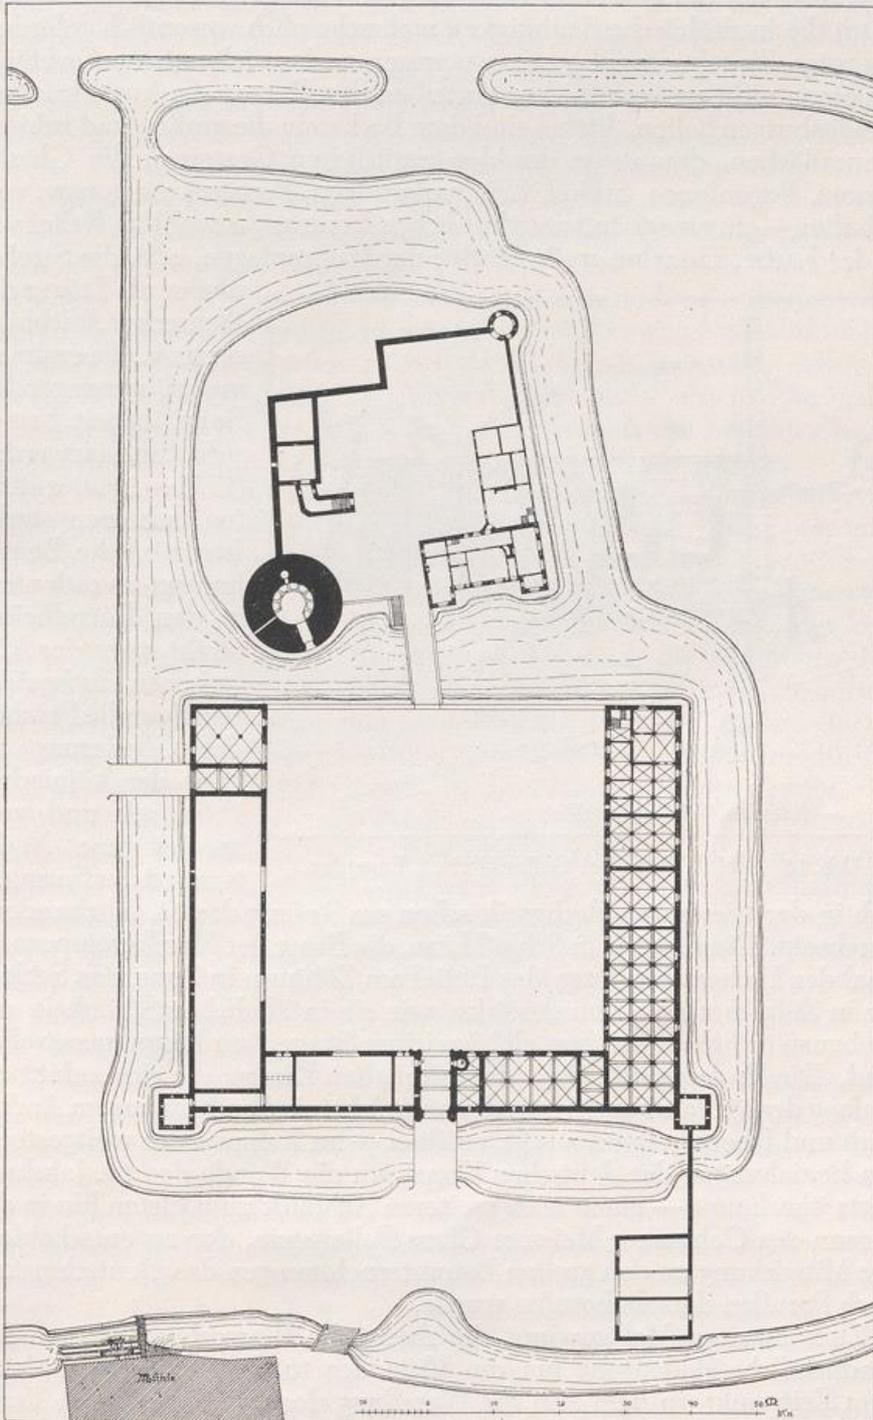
Schloß Müllenark, Grundriß. — Hochburg mit Batterieturm, Anfang des 16. Jahrhunderts, Vorburg 1670 (Wasserläufe ergänzt).
